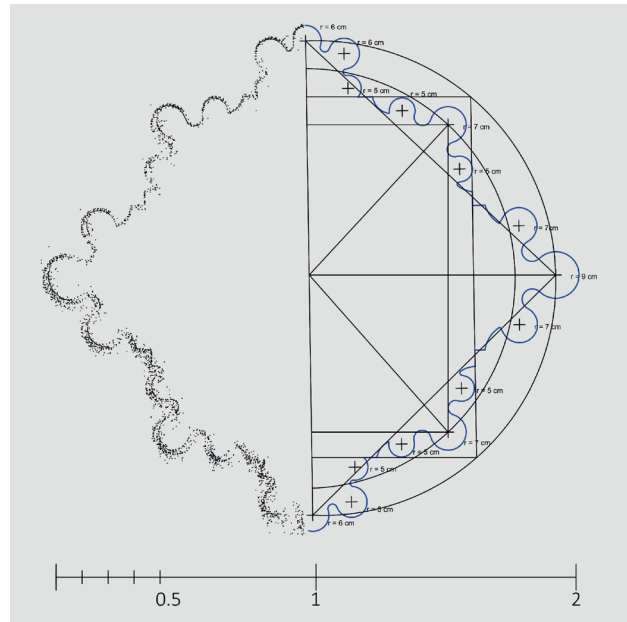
Die unscharfe Punktwolke eines Pfeilergrundrisses des terrestrischen Laserscanners wird bauteilgerecht nachkonstruiert und so selbst zum Träger erweiterter Informationen [Nöbauer / Salzer 2020].
